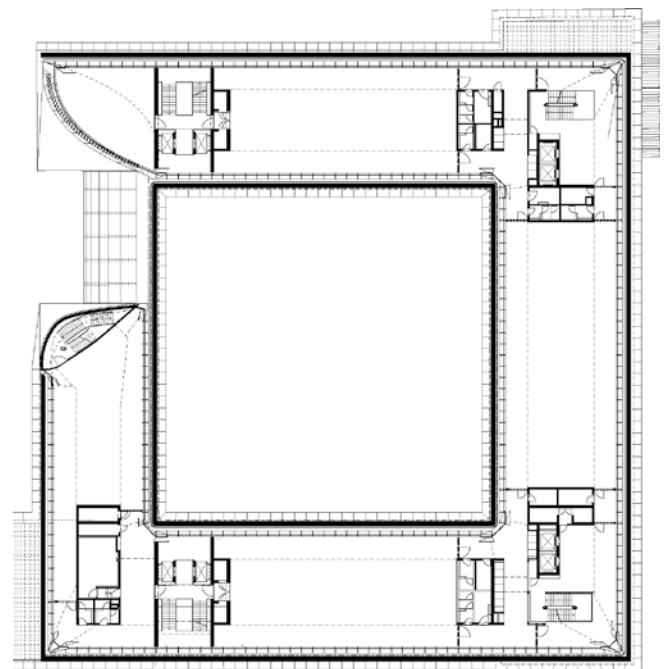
Grundriss 6. OG © Schneider & Schumacher
